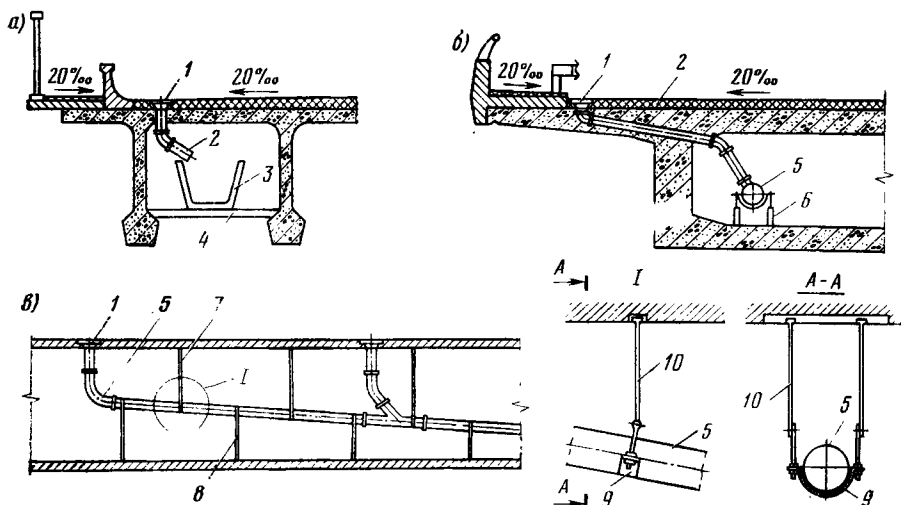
Схемы водоотвода в городских мостах, эстакадах и путепроводах: 1 — воронка; 2 — водоотводная трубка; 3 — железобетонный лоток; 4 — поперечины; 5 — продольная отводящая труба; 6 — опорное устройство; 7 — подвеска; 8 — стойка; 9 — хомут; 10 — стержень подвески
